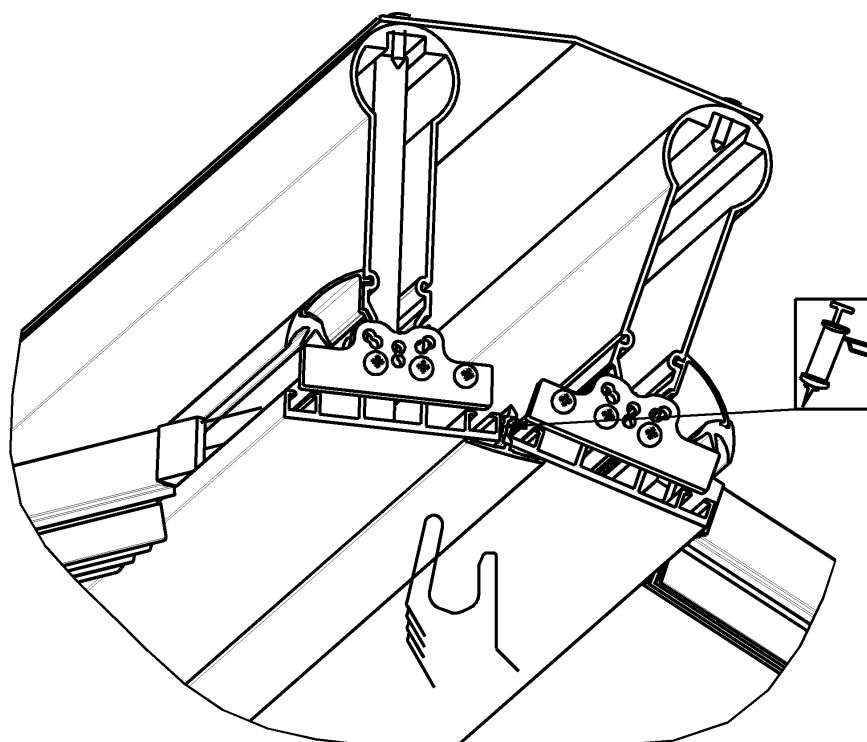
Afdichten van de kier tussen de dakdragers
